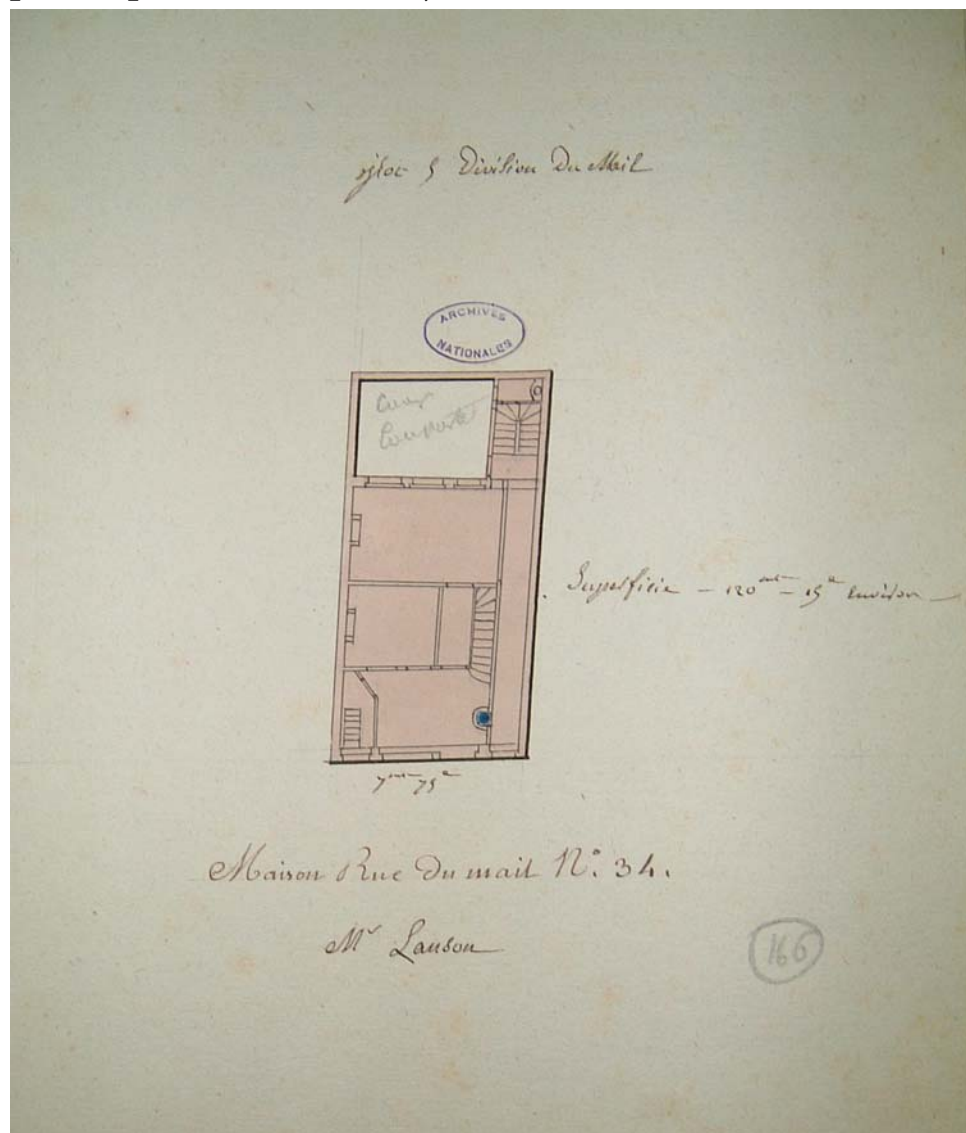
Reprise d'un plan de maison dans un plan d'îlot : exemple du n°34 de la rue du Mail
